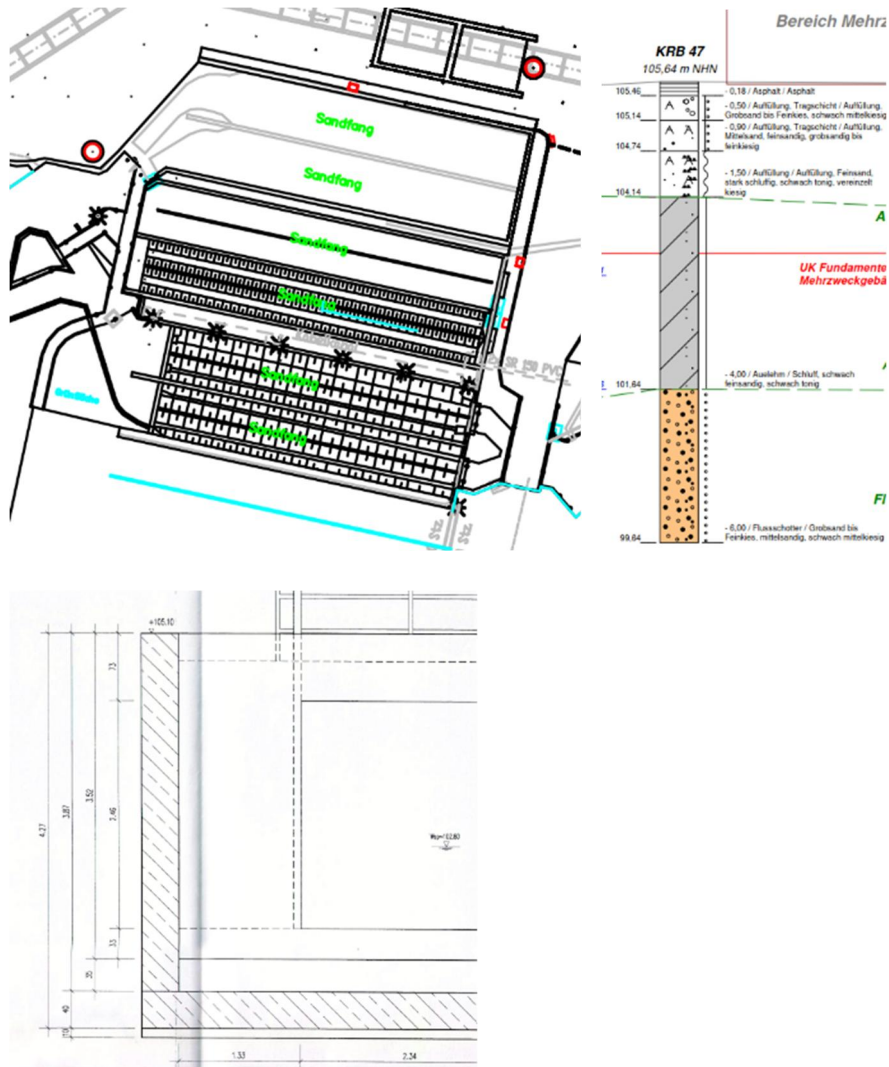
Sandfang – Lageplan, Schnitt [U8] und Schichtenverlauf [U6]
